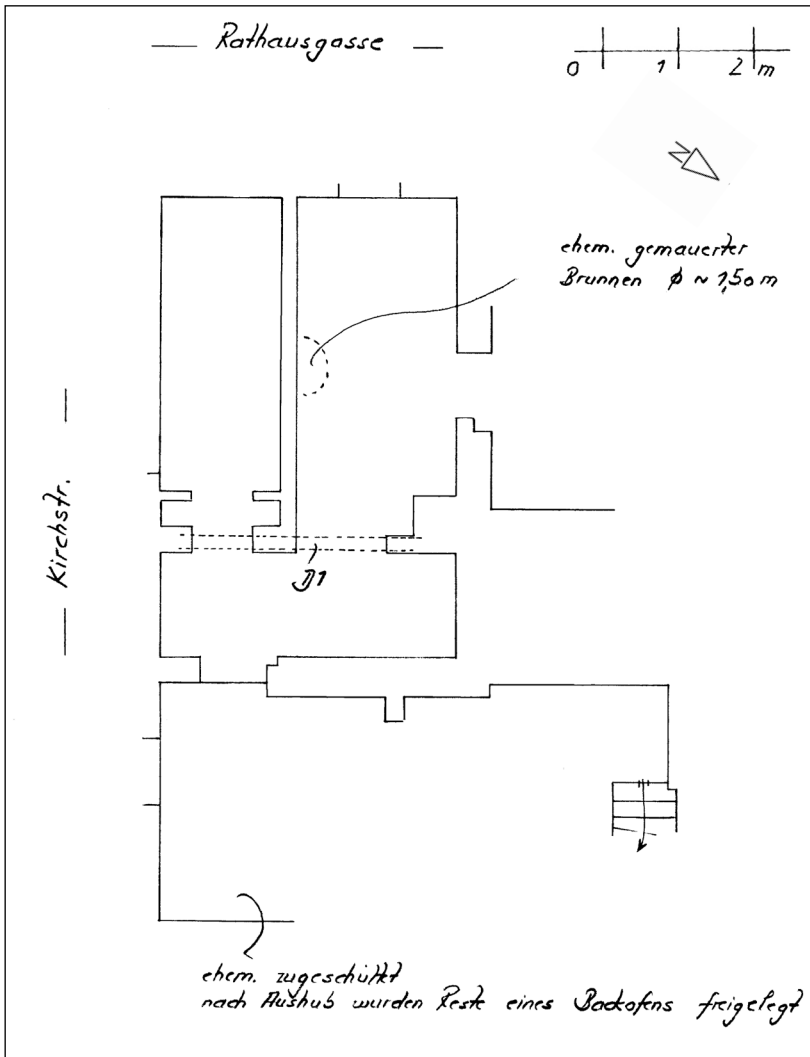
Kirchstraße 1, Grundriss Keller.
